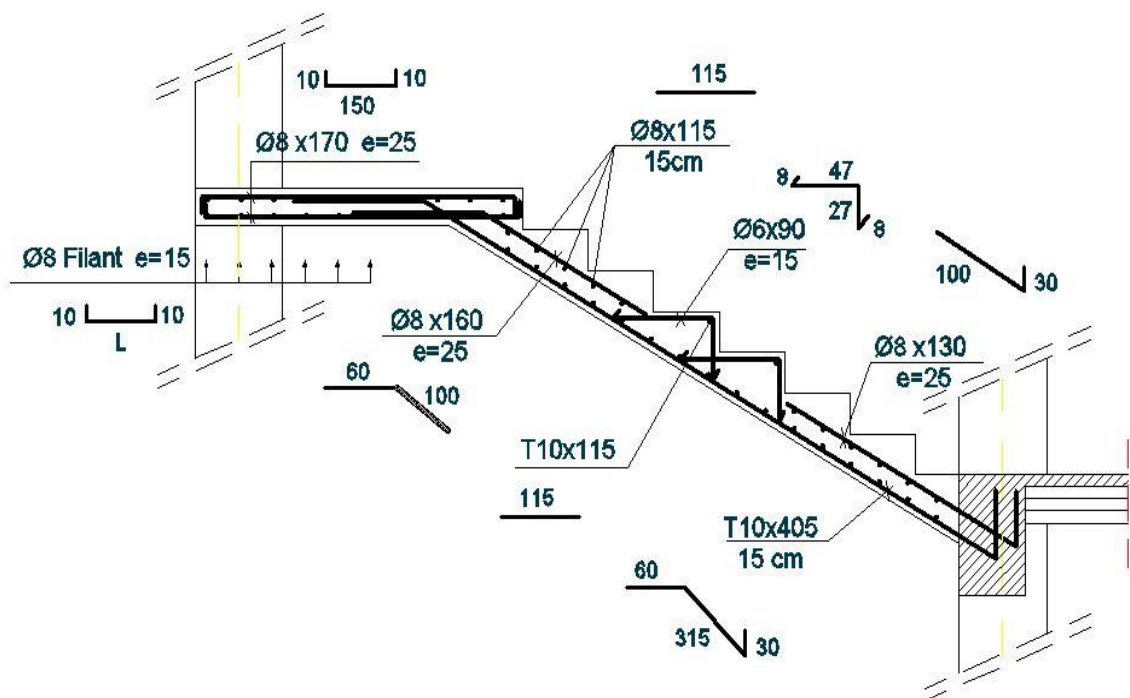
N°14 : Dessin de ferrailage de l'escalier à paillasse porteuse.
